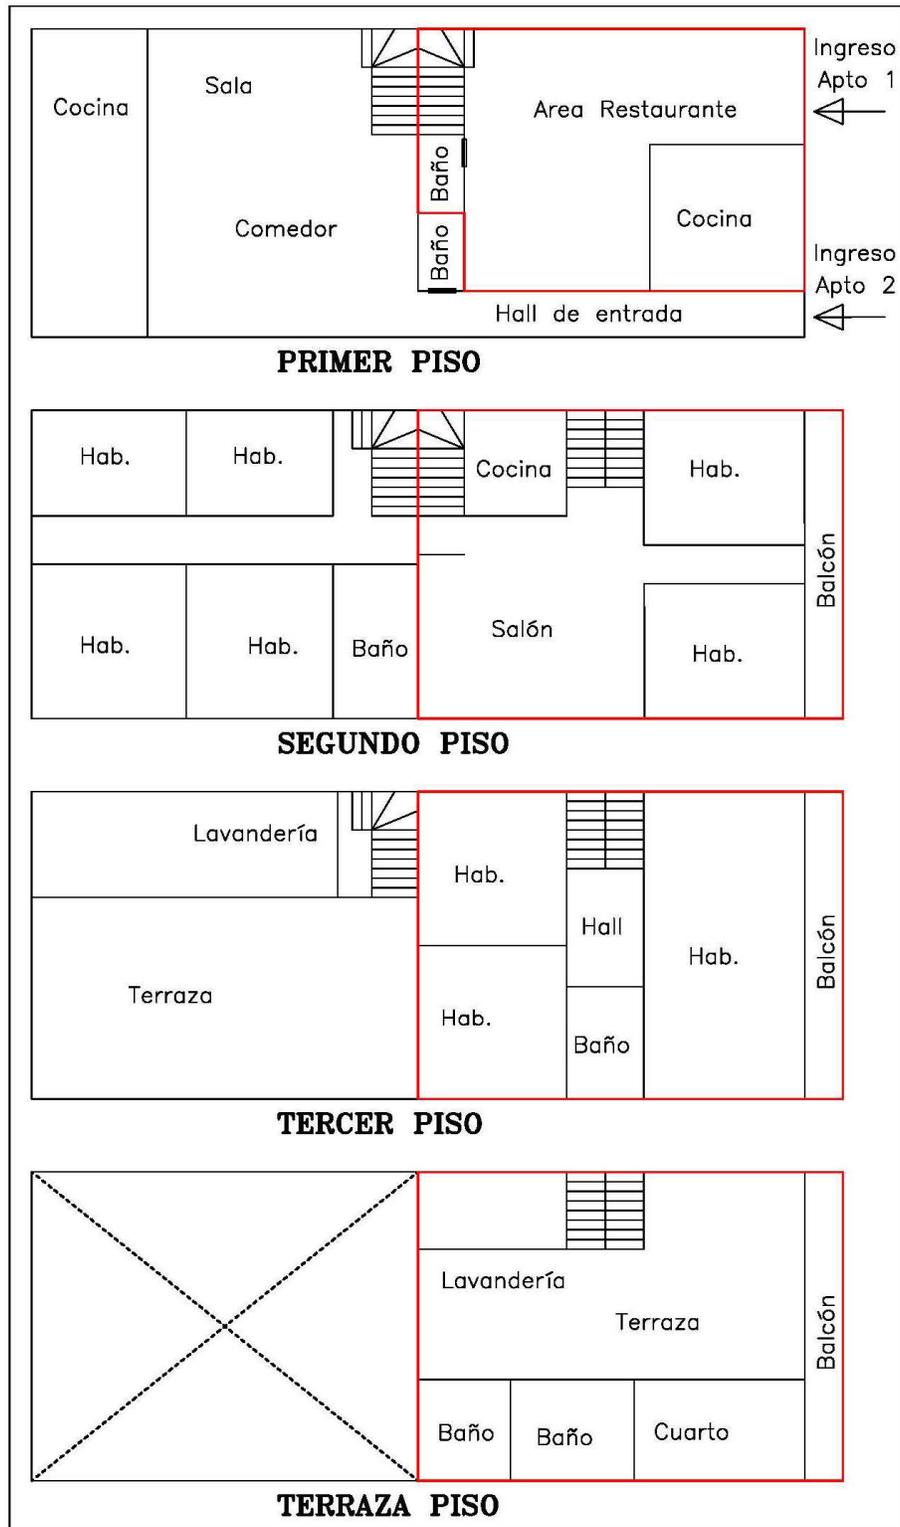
Croquis distribución arquitectónica inmueble. Sombreado en rojo apartamento 1, no sombreado apartamento 2.
